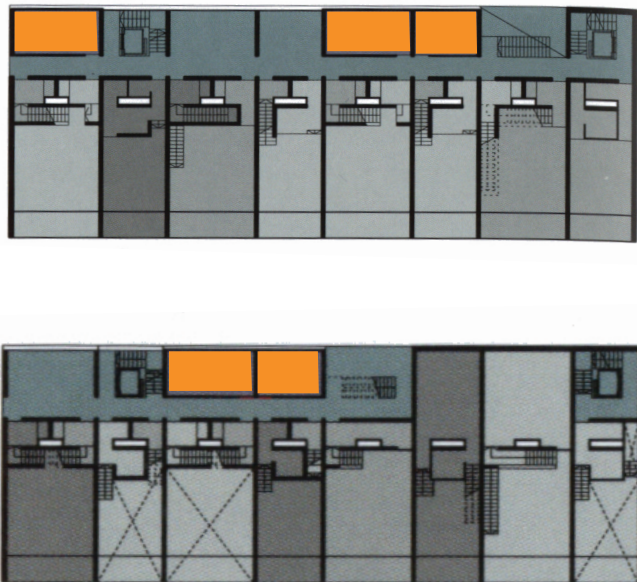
Grundrisse Wienerberger City Delugan\_Meissl
